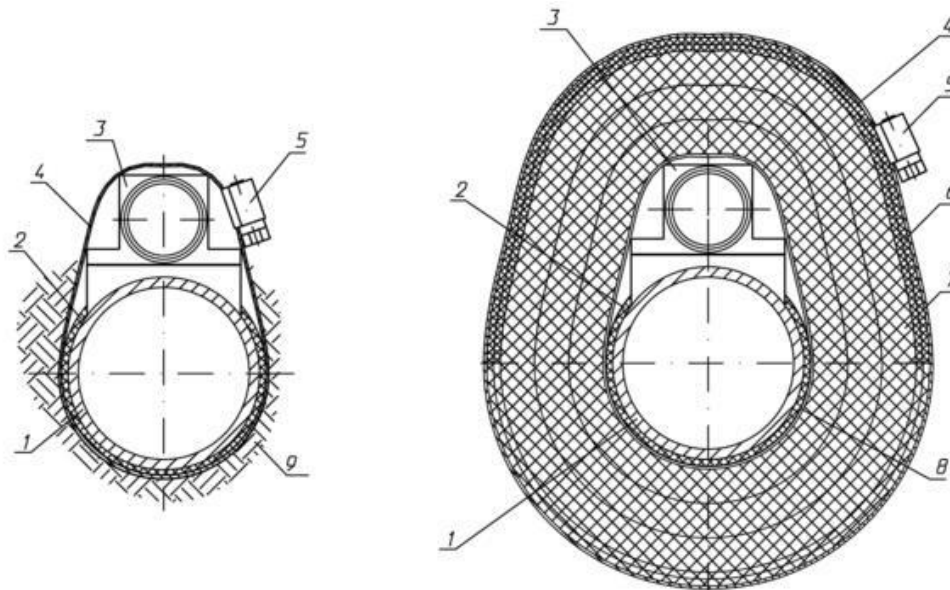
Схема установки и крепления ТС с корпусом типа «К2» на трубопроводе
